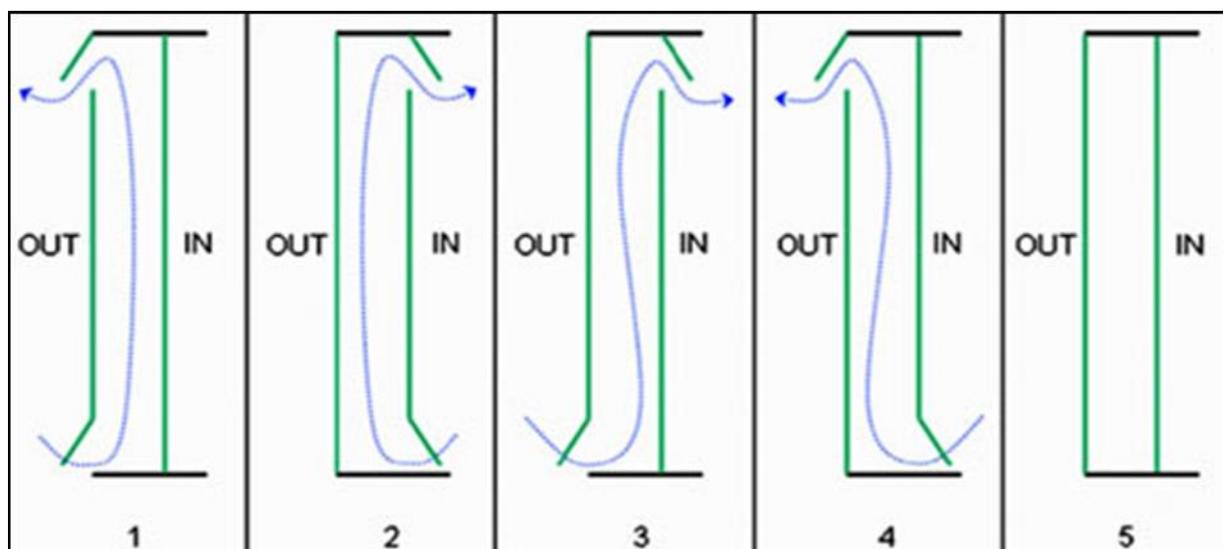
Les modes de la ventilation de virage double peau (source : [www.bestfacade.com](http://www.bestfacade.com))
